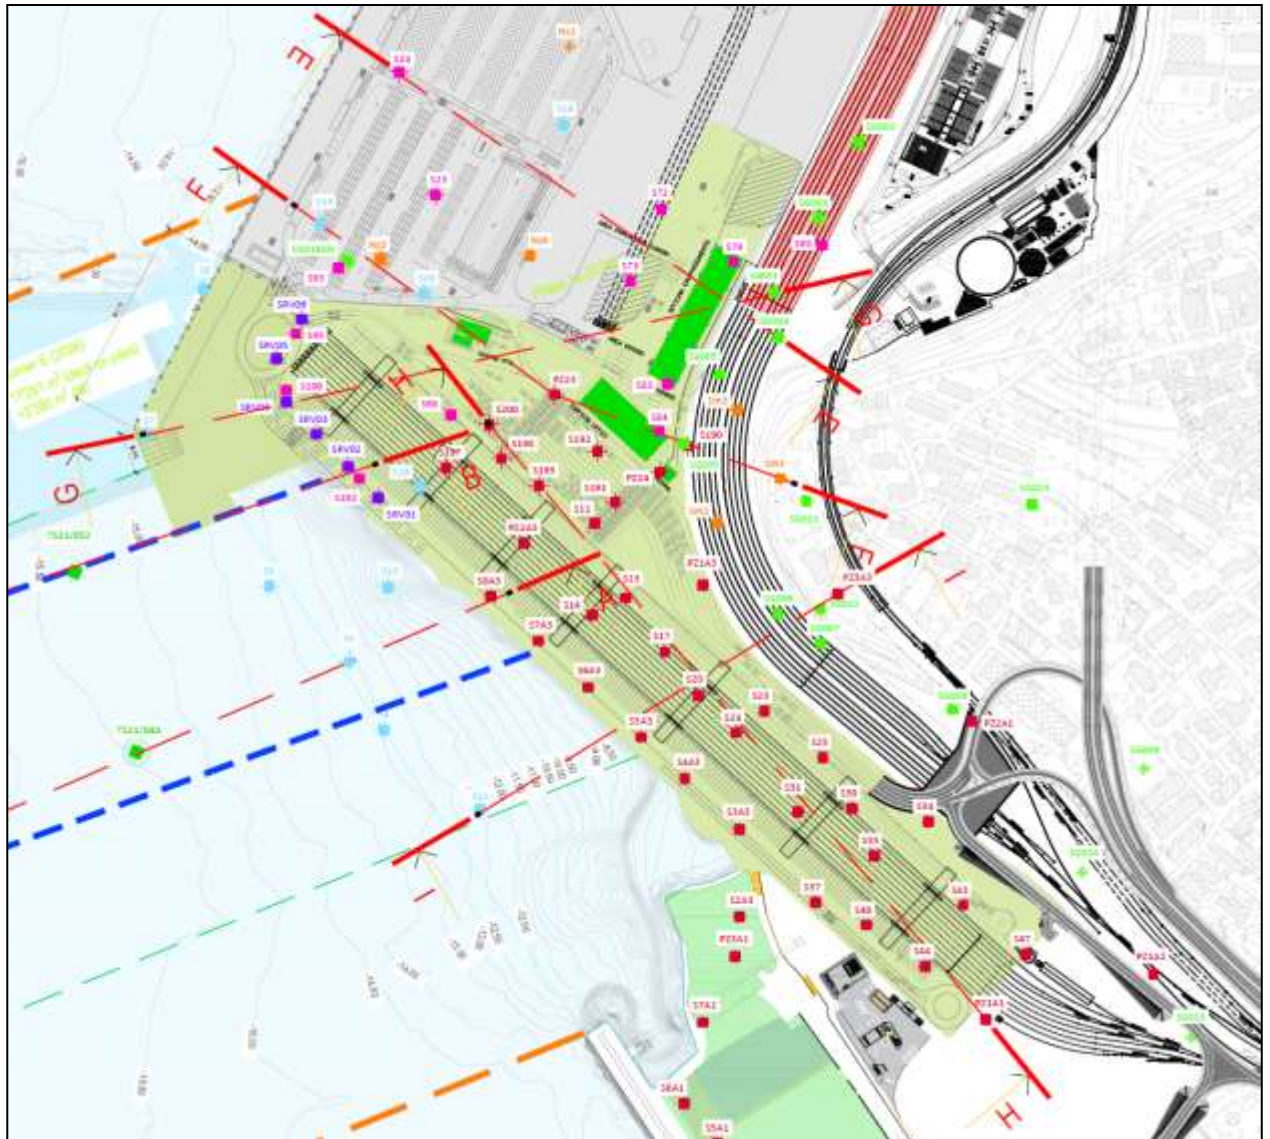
Planimetria delle sezioni geologiche di riferimento
